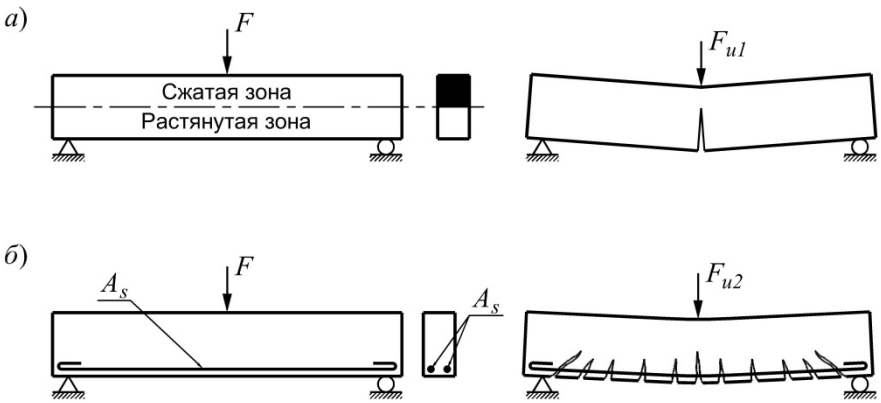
Разрушение бетонной (а) и железобетонной (б) балок
